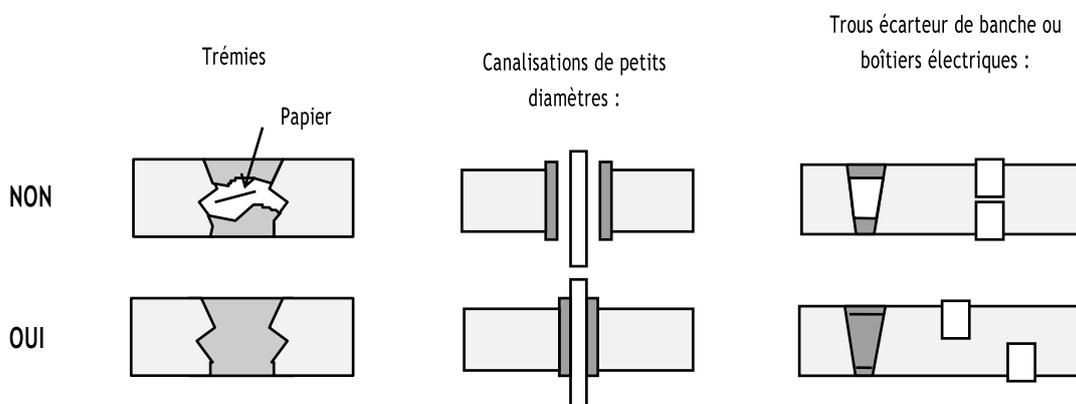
Principe de traitement de l'indice d'affaiblissement des voiles ou des planchers en béton.
